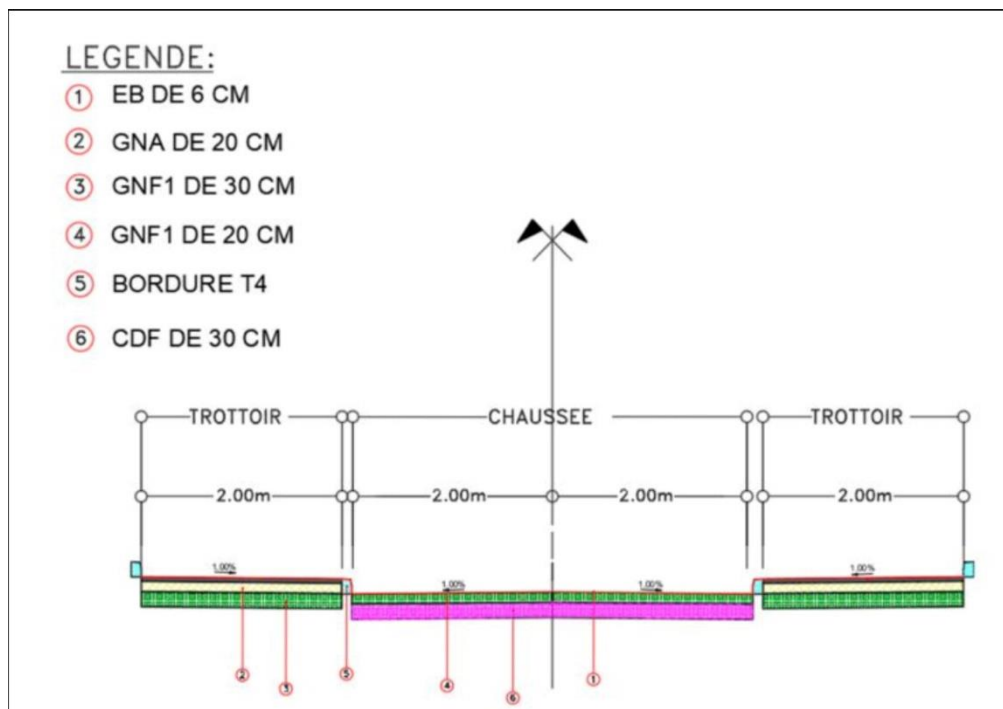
Profil en travers type — Structure de chaussée (Légende des couches)
